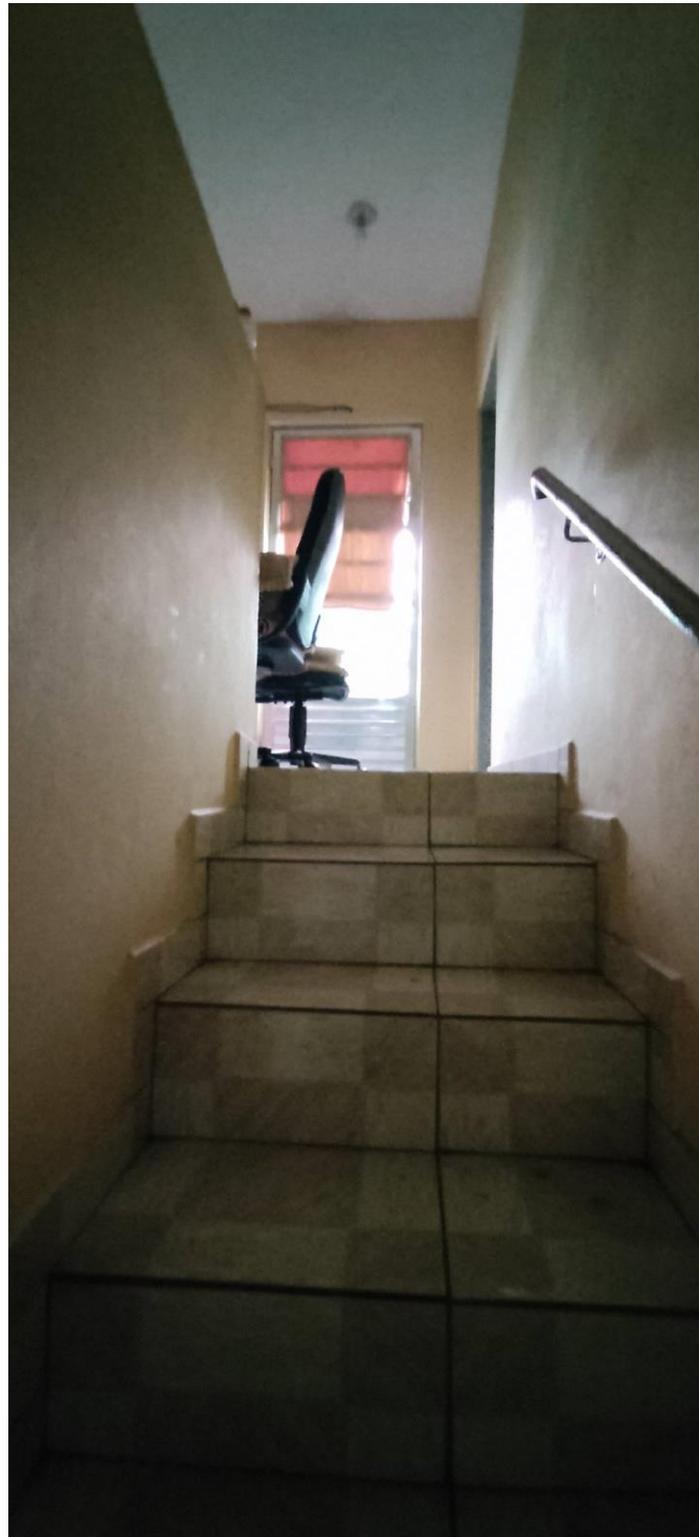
Sobrado 01 - térreo: escada, acesso ao pavimento superior.
